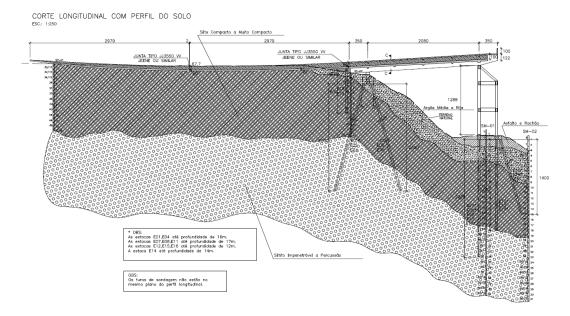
Seção longitudinal- Área de Escape Km 49+200 Pista Sul - SP-150
